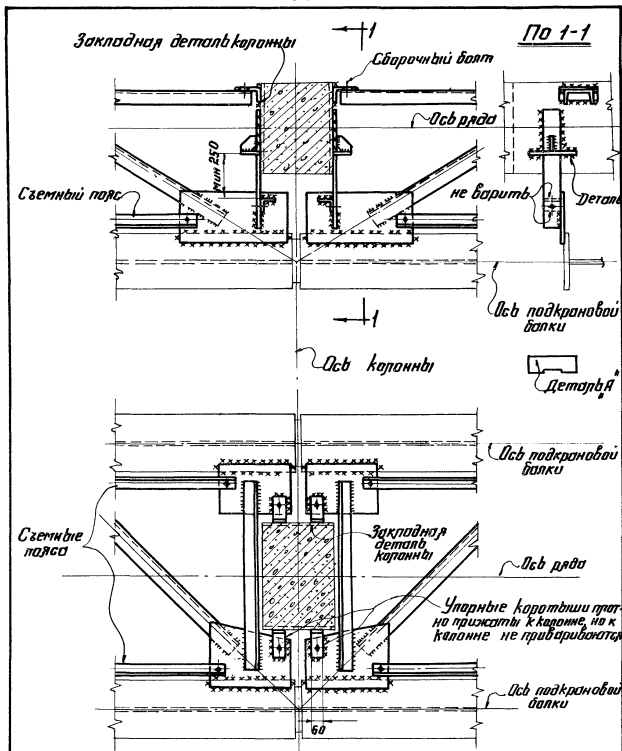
Крепление верхнего пояса разрезных подкрановых балок к железобетонным колоннам при наличии тормозных ферм:
